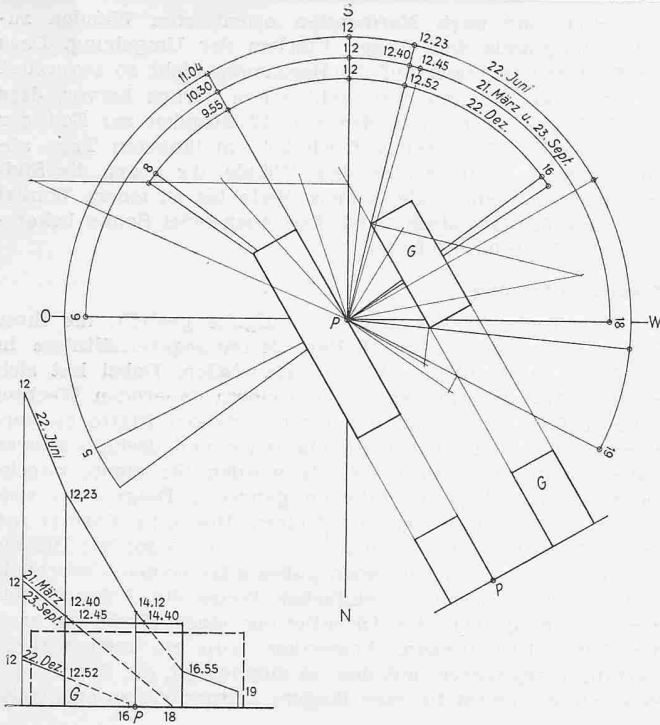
Sonnenbestrahlung eines Punktes der Fassade mit gegenüberliegendem Gebäude
